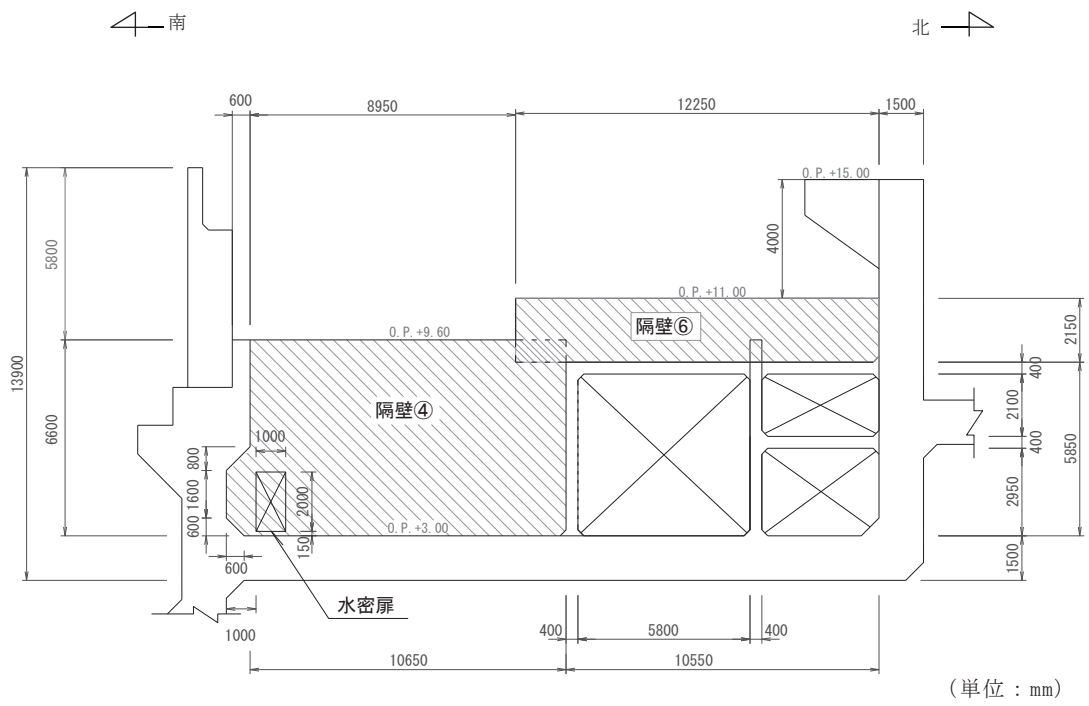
(4) 補機ポンプエリア断面図 (④—④断面)
